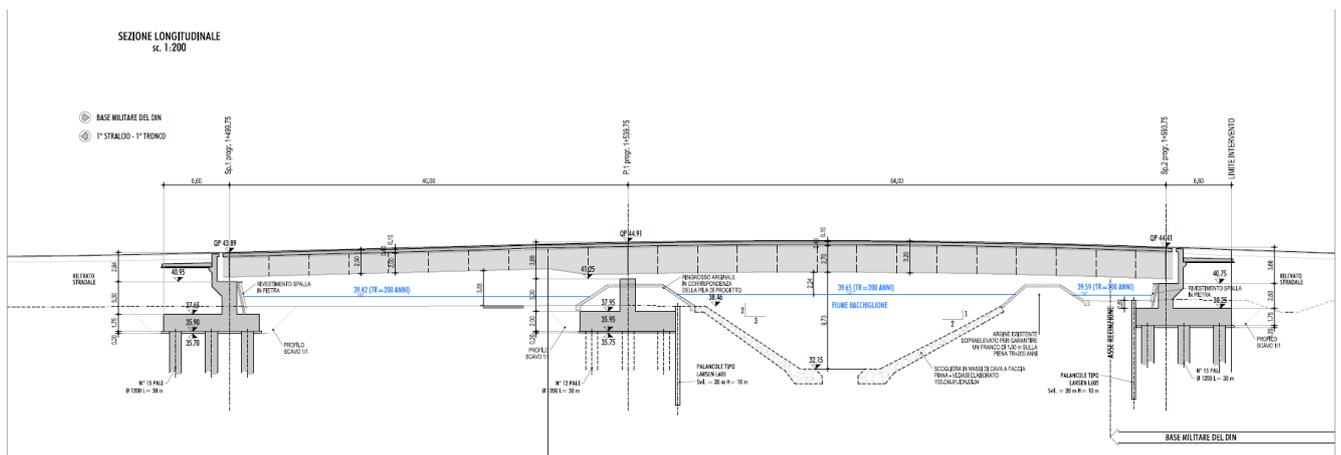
SEZIONE LONGITUDINALE DEL PONTE
